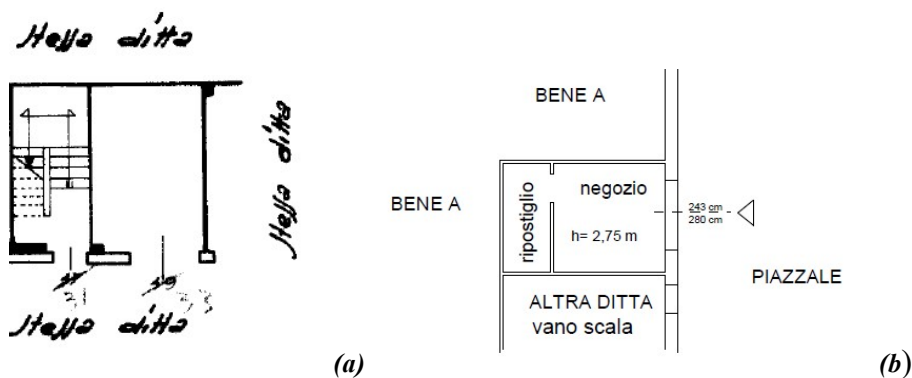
Planimetrie del Bene B ubicato in via Napoli n° 33: planimetria catastale (a); planimetria attuale (b).
